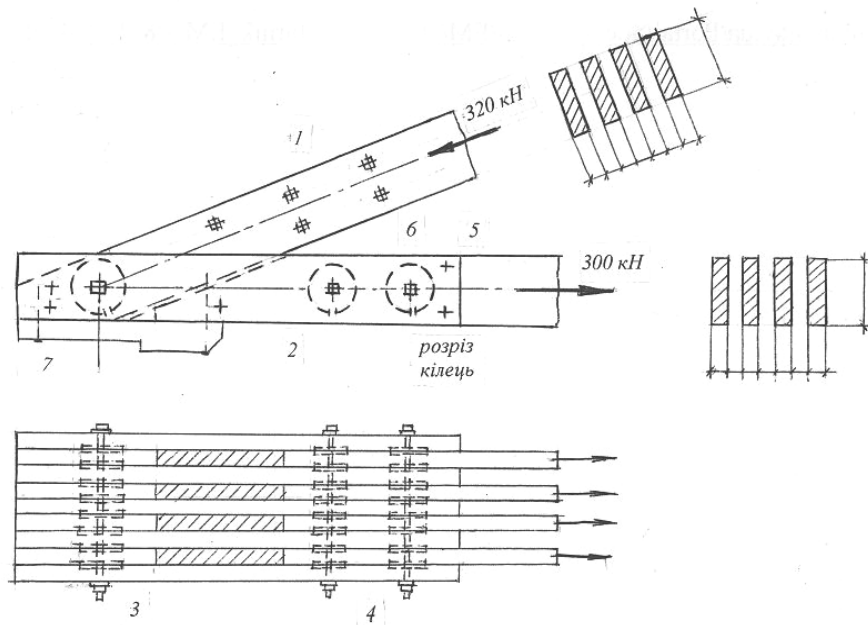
Опорний вузол ферми і стик нижнього поясу
